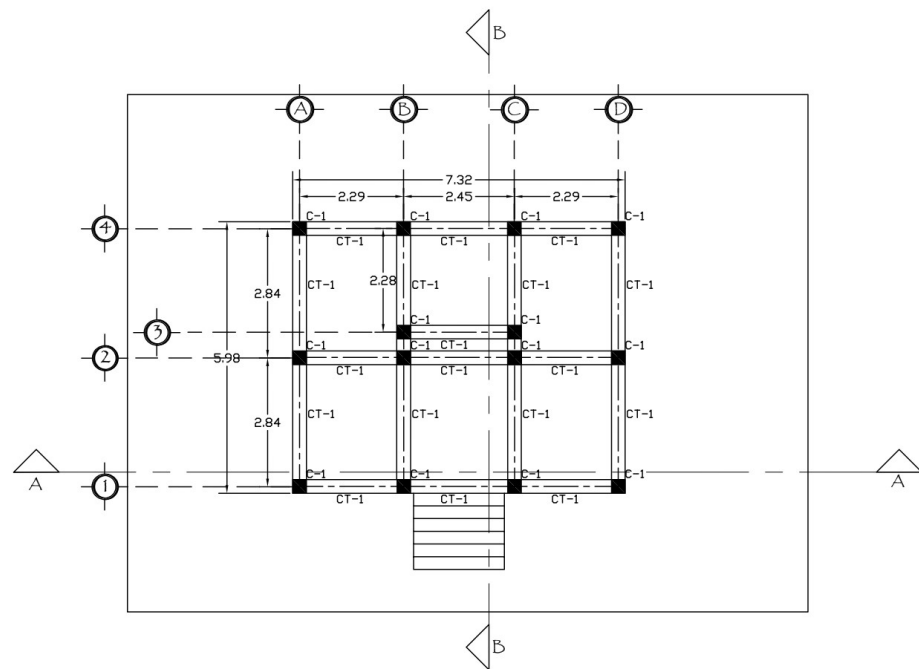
Planta Cimentación Tipología - A - Elaboración propia
